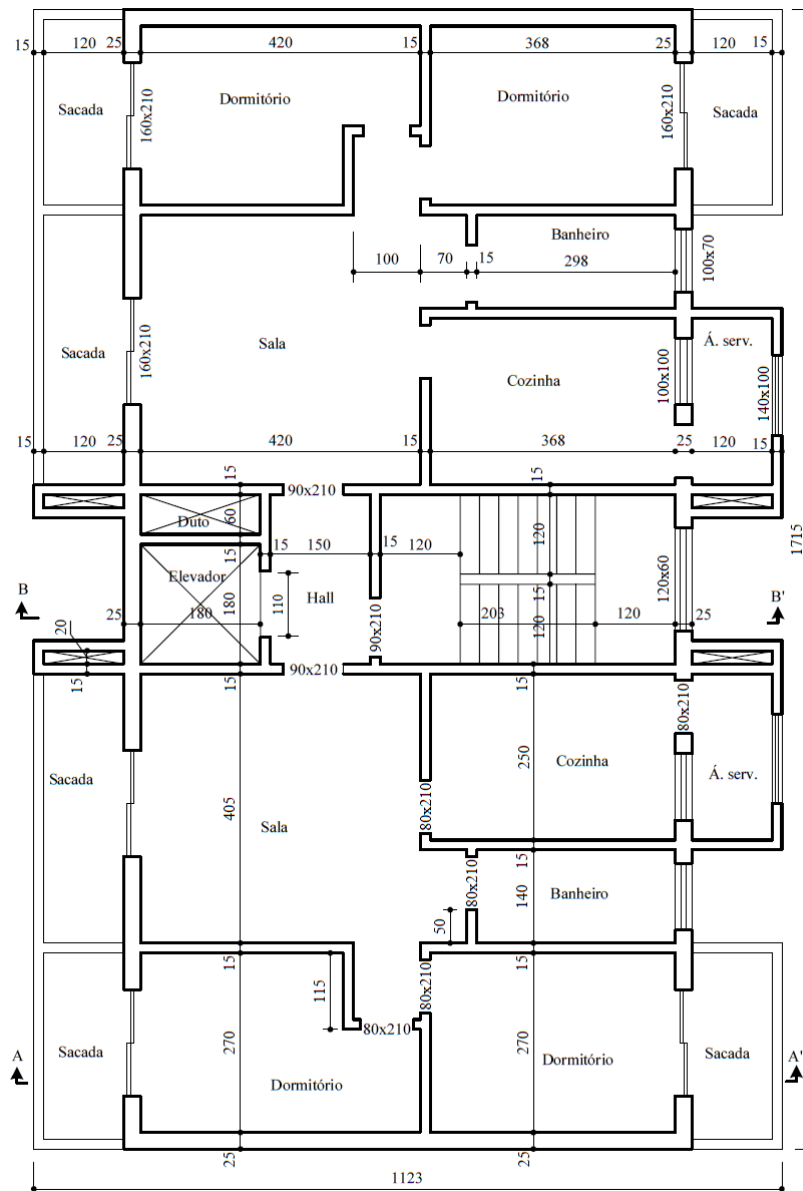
Planta baixa do pavimento tipo. Adaptado de Araújo [7]
